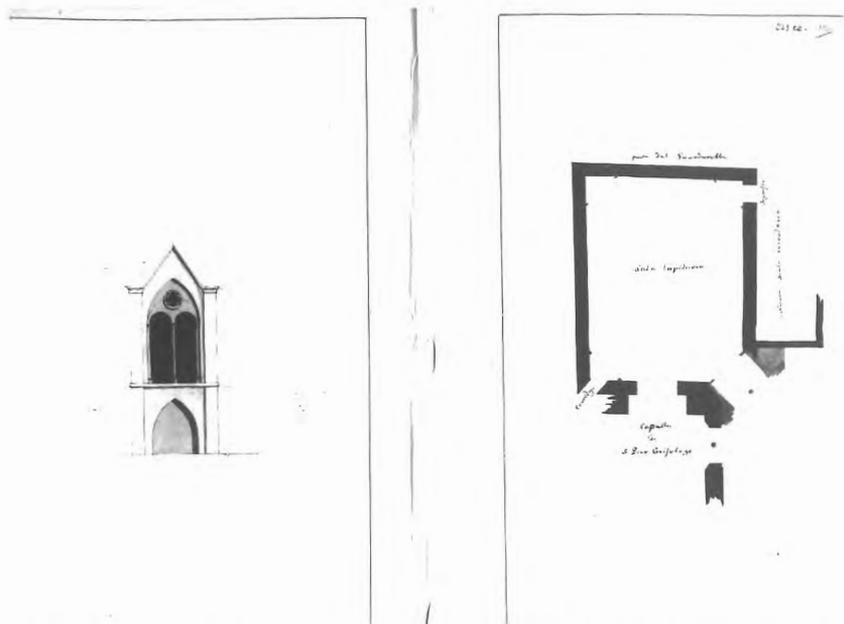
Progetto di realizzazione dello sporto della Sala Lapidaria Pianta e prospetto (BSF, Fondo Piancastelli, Carte Romagna, busta 223, c.132).
